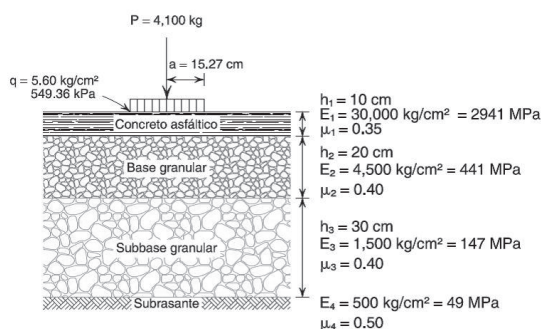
MODELO ESTRUCTURAL DE REFERENCIA DE PAVIMENTO FLEXIBLE
